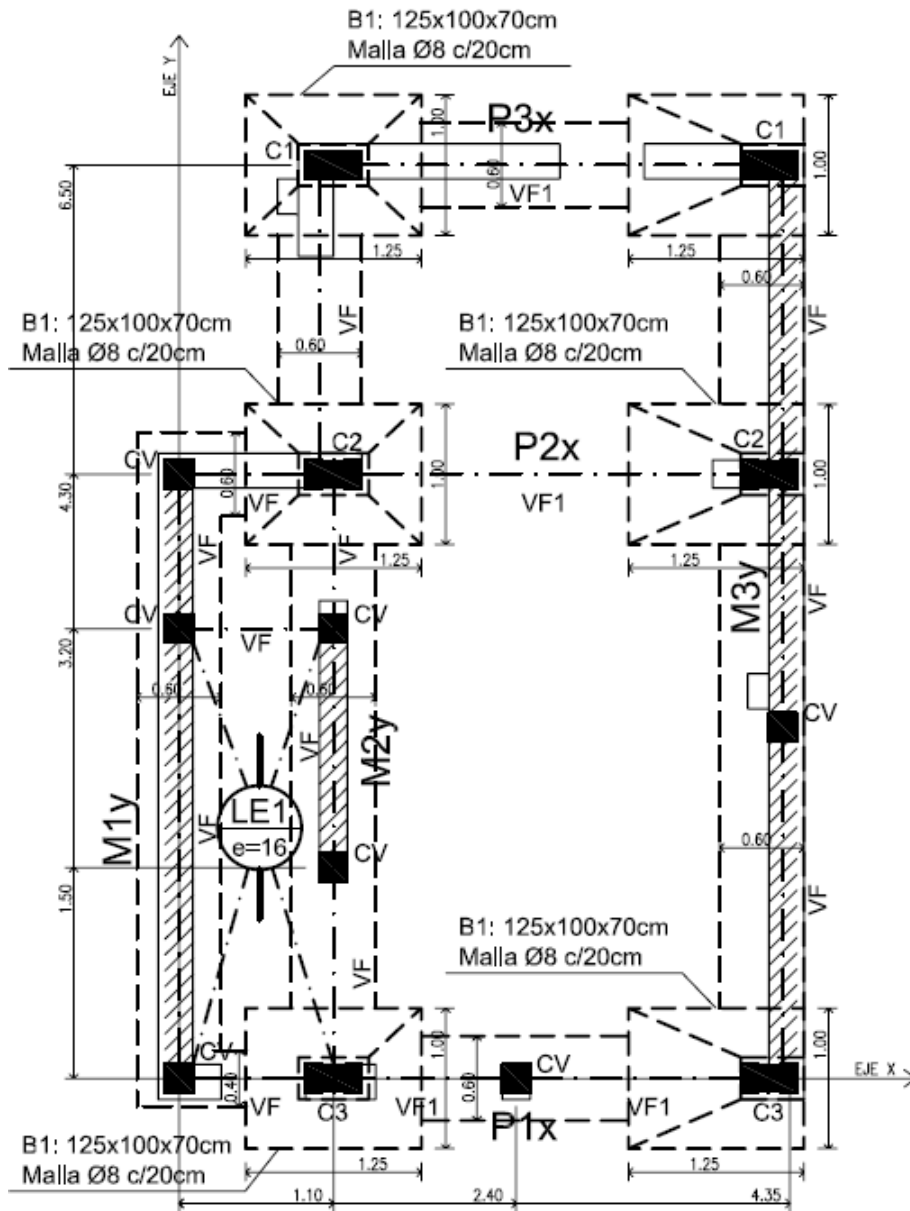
Planta de fundaciones de la vivienda de dos plantas.
